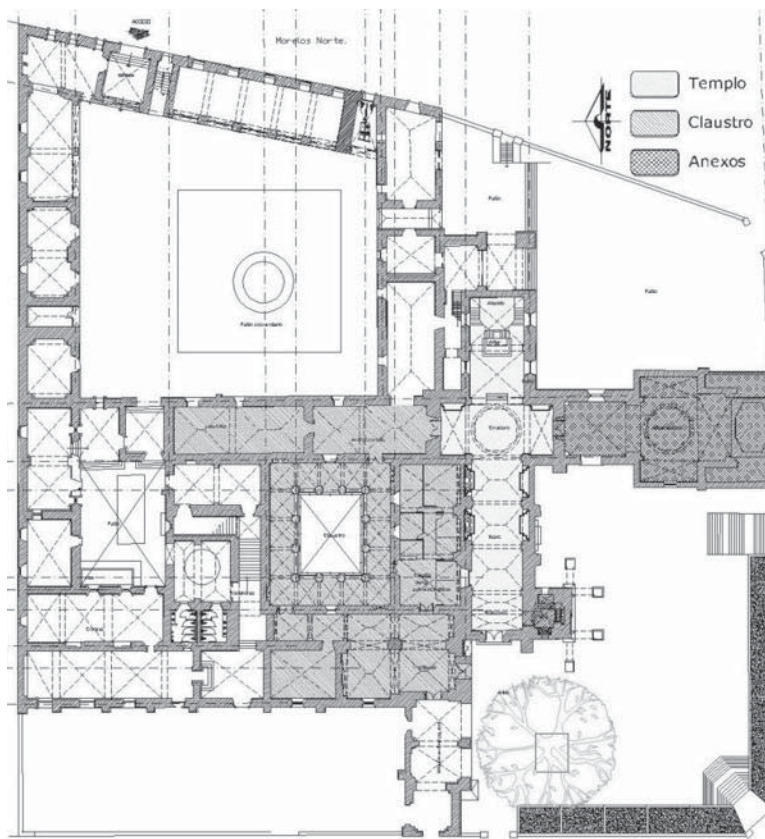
, planta de conjunto (planta baja) en el cual se especifica la distribución de áreas
